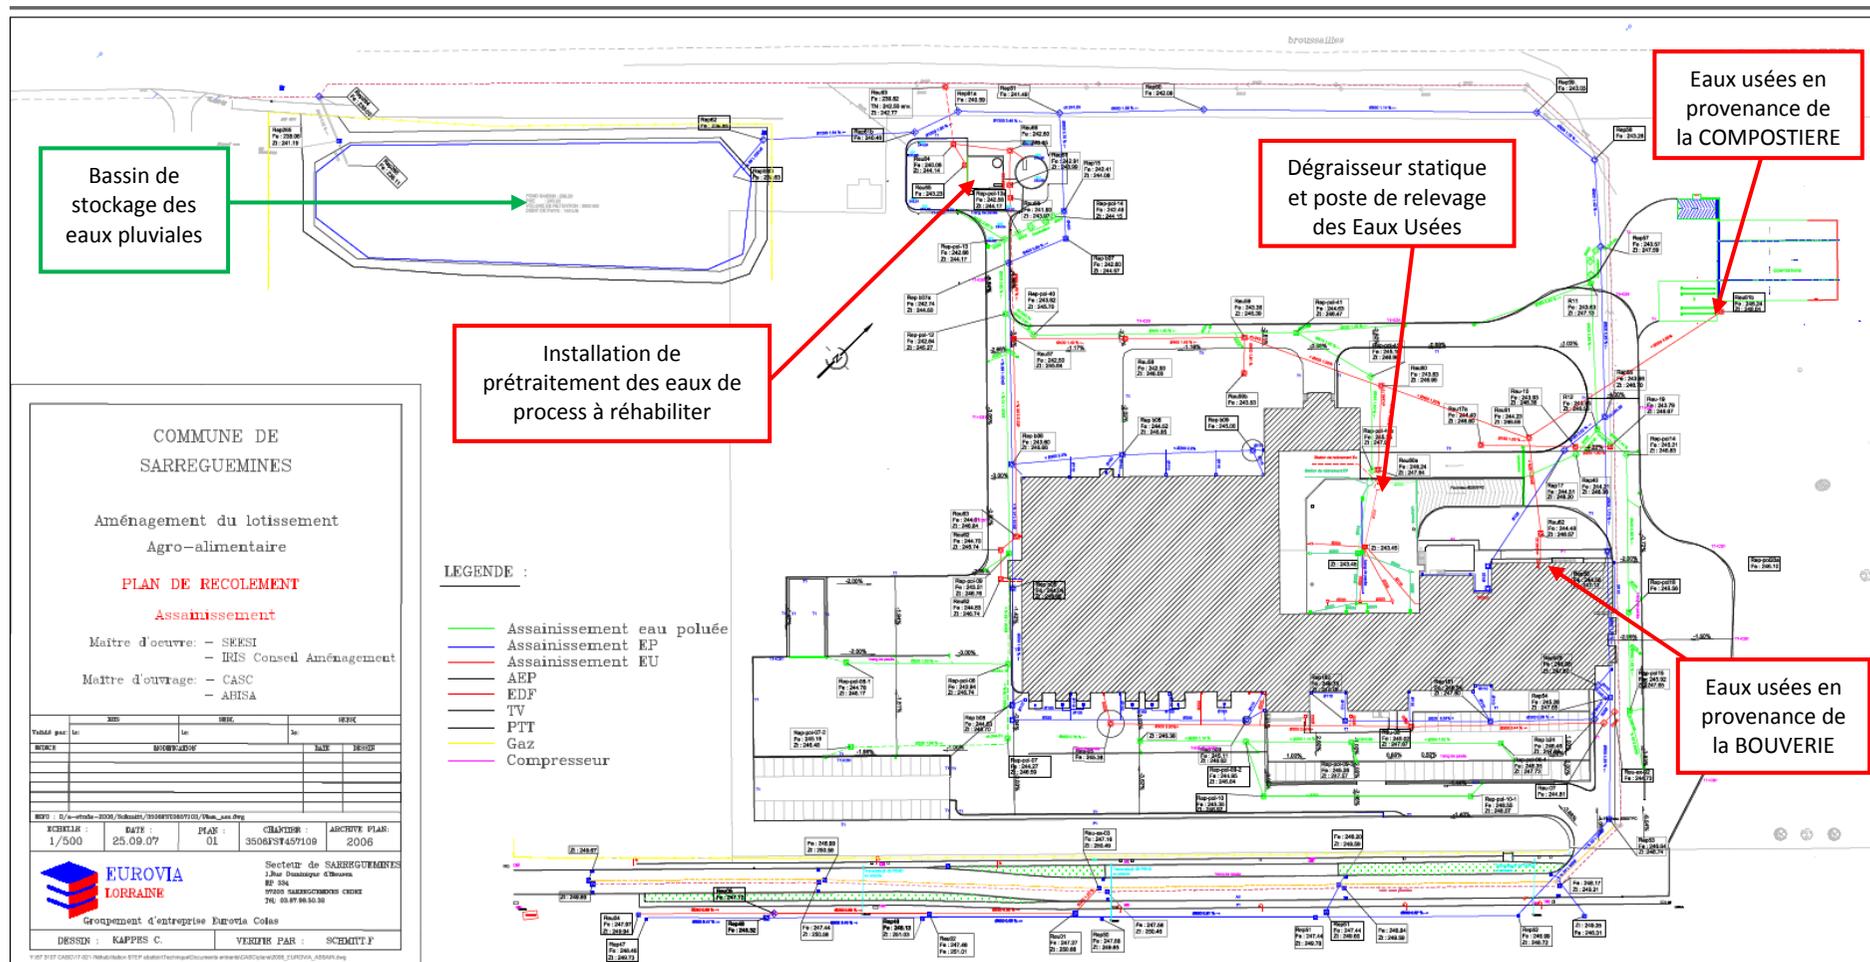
Plan des réseaux d'assainissement de l'abattoir
